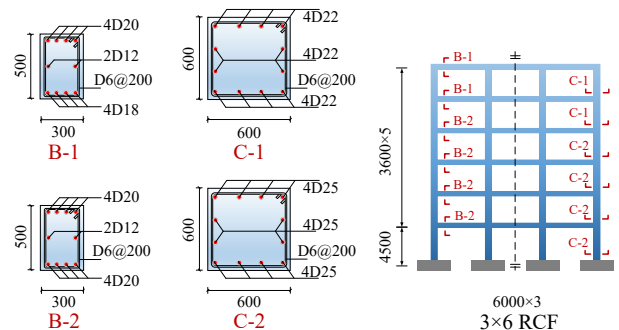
钢筋混凝土框架的尺寸与配筋信息 (单位: mm)
